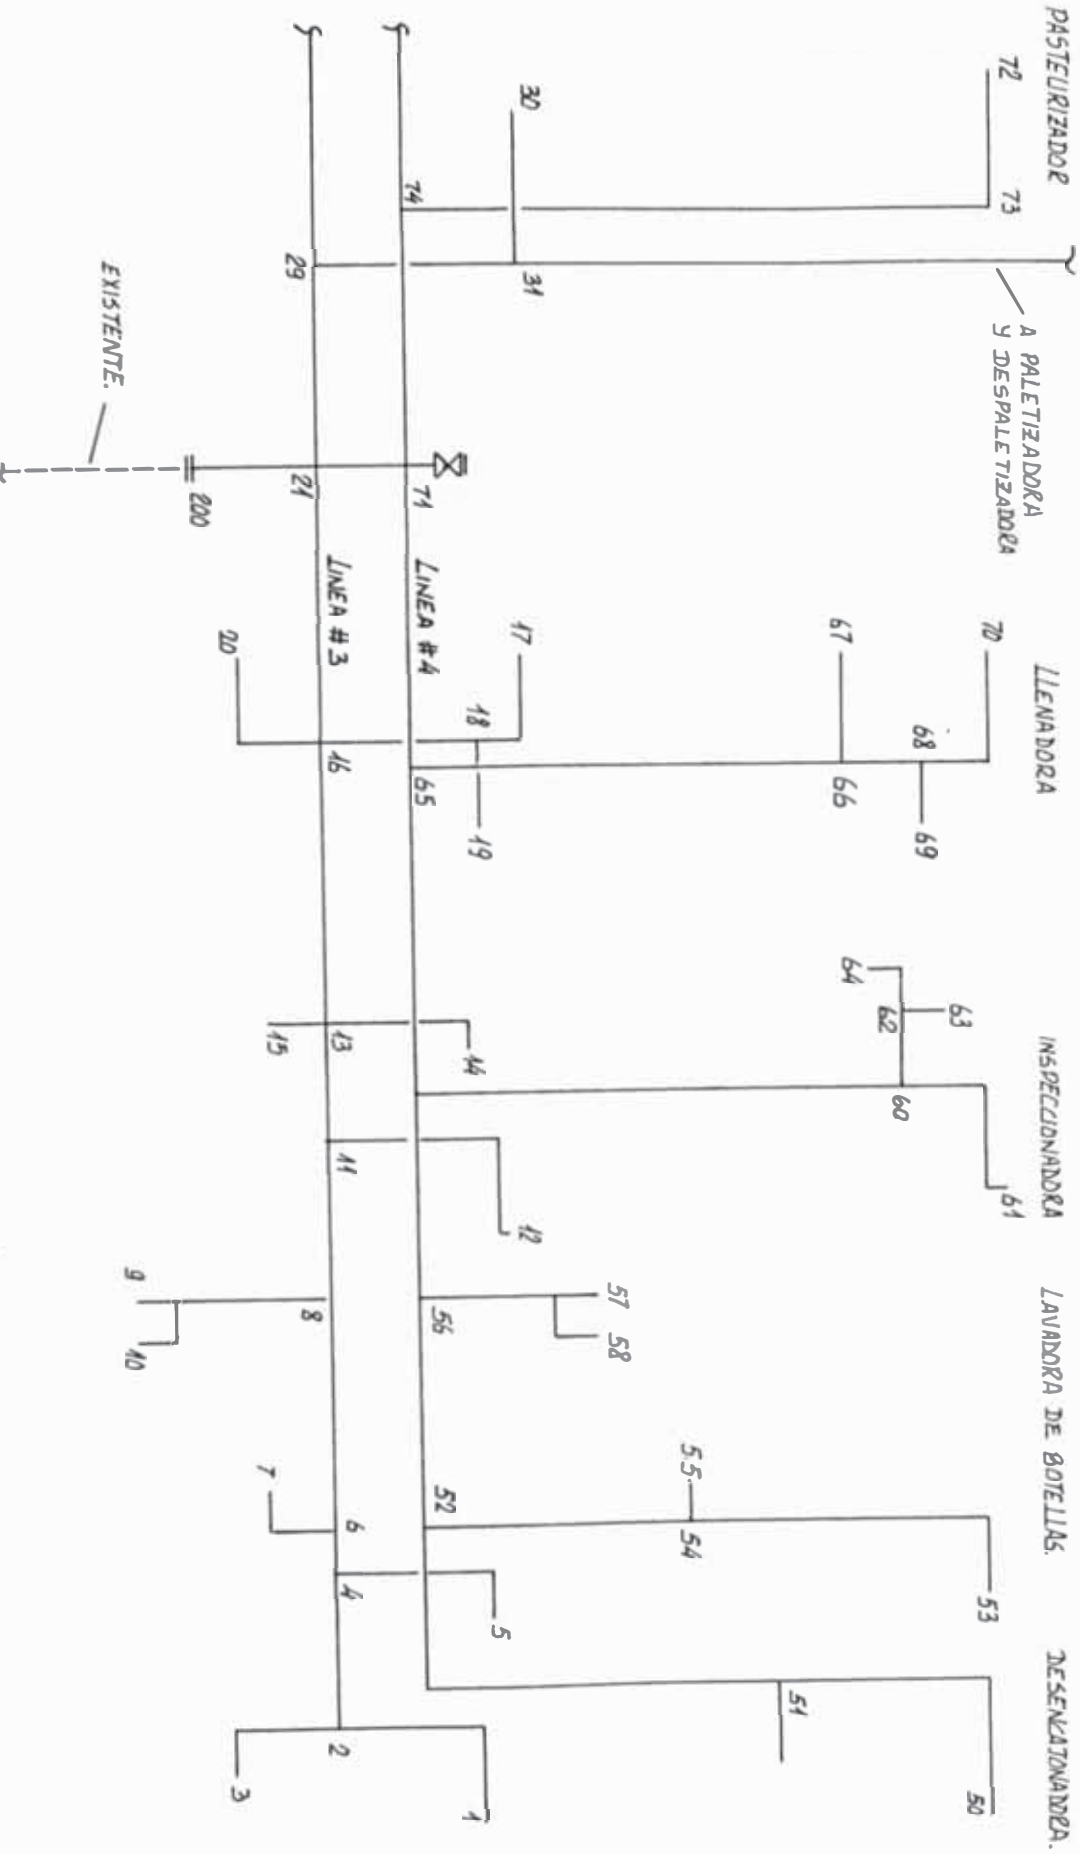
b. ESQUEMA DE LA DISPOSICION DEL AGUA FRIA - ENTRE COLUMNAS 19-36.
